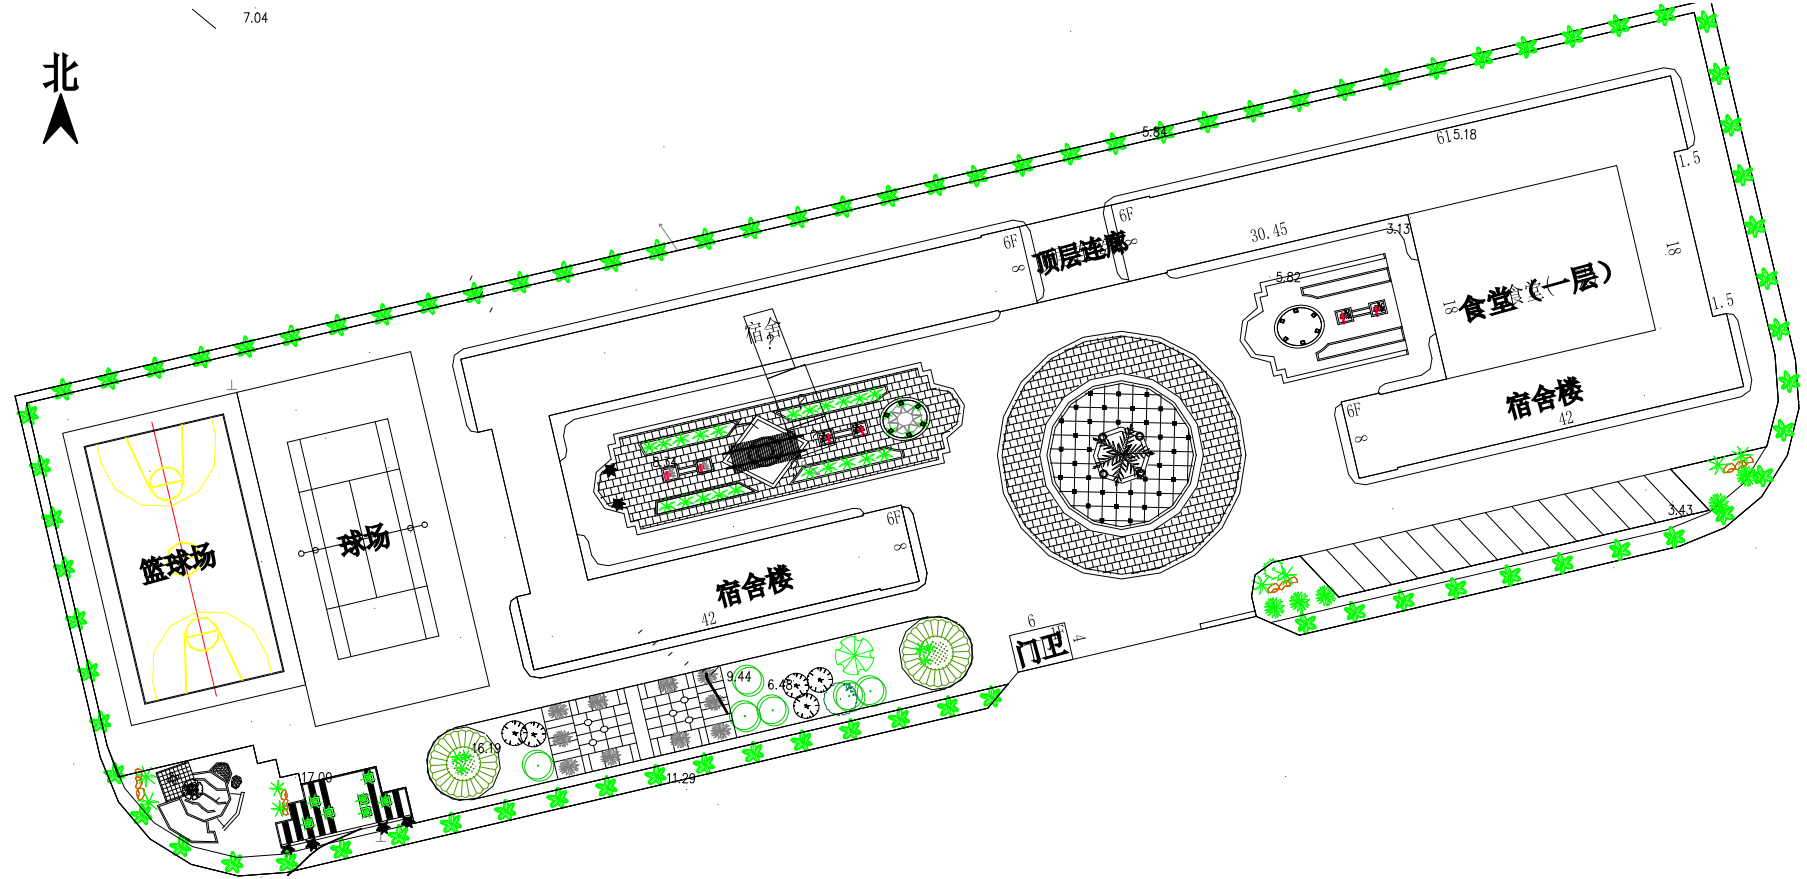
改扩建后项目生活区平面图（与原来一致）
